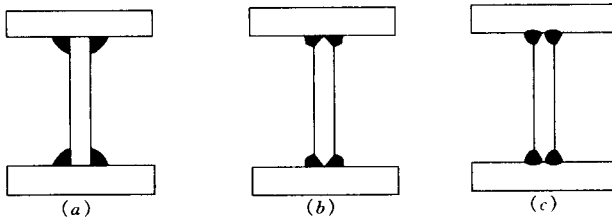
角焊缝、全焊透及部分焊透对接与角接组合焊缝示意
